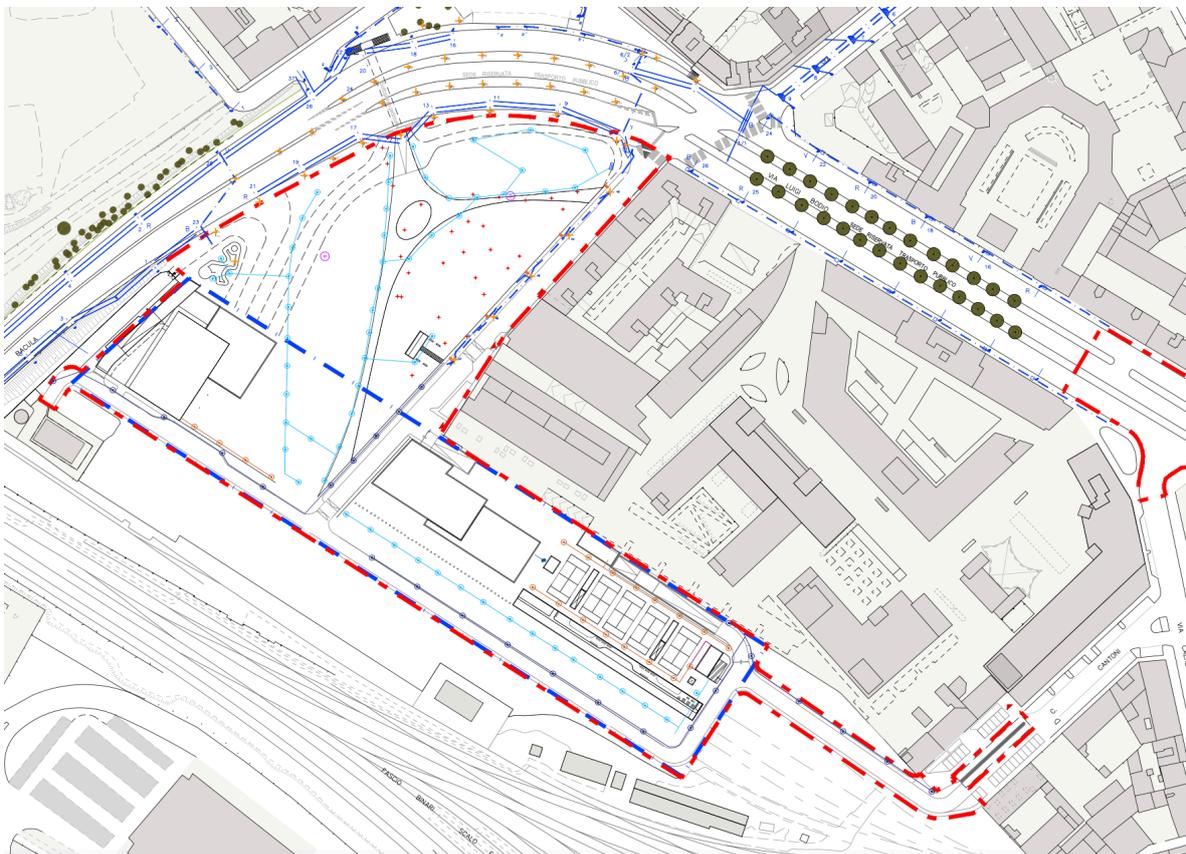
Rete di illuminazione pubblica (rif tav. 21IRM015-PP-SER-DR-F.03)
